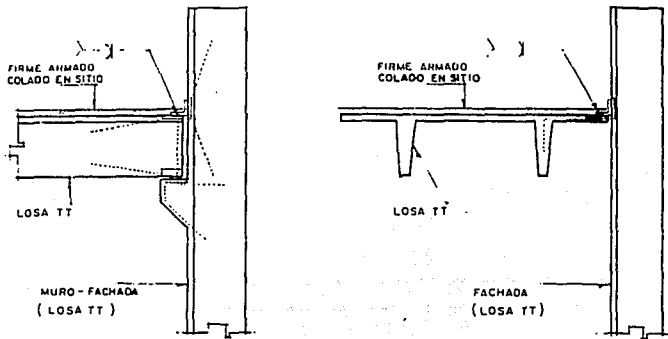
Estructuración Mediante Elementos Prefabricados.
